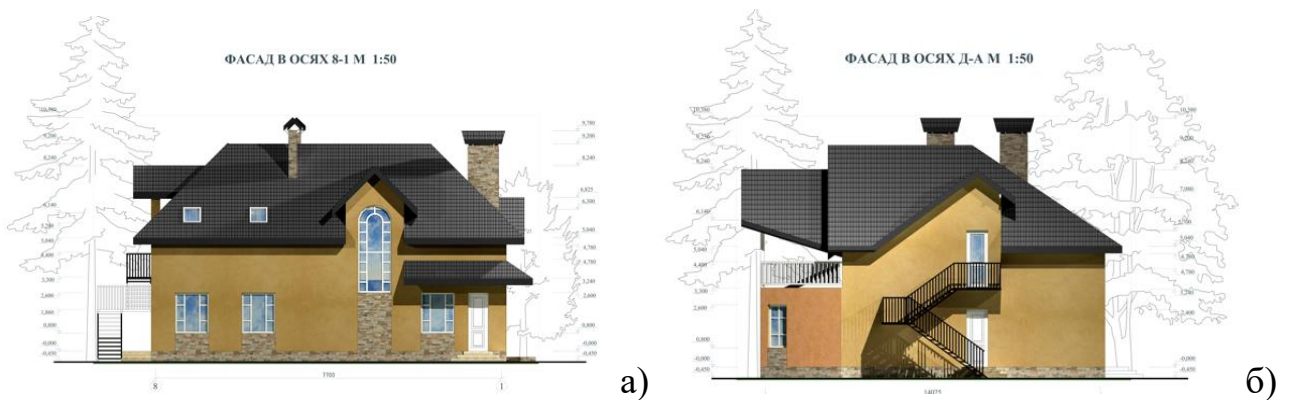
а) Фасад в осях 8-1; б) Фасад в осях Д - А
